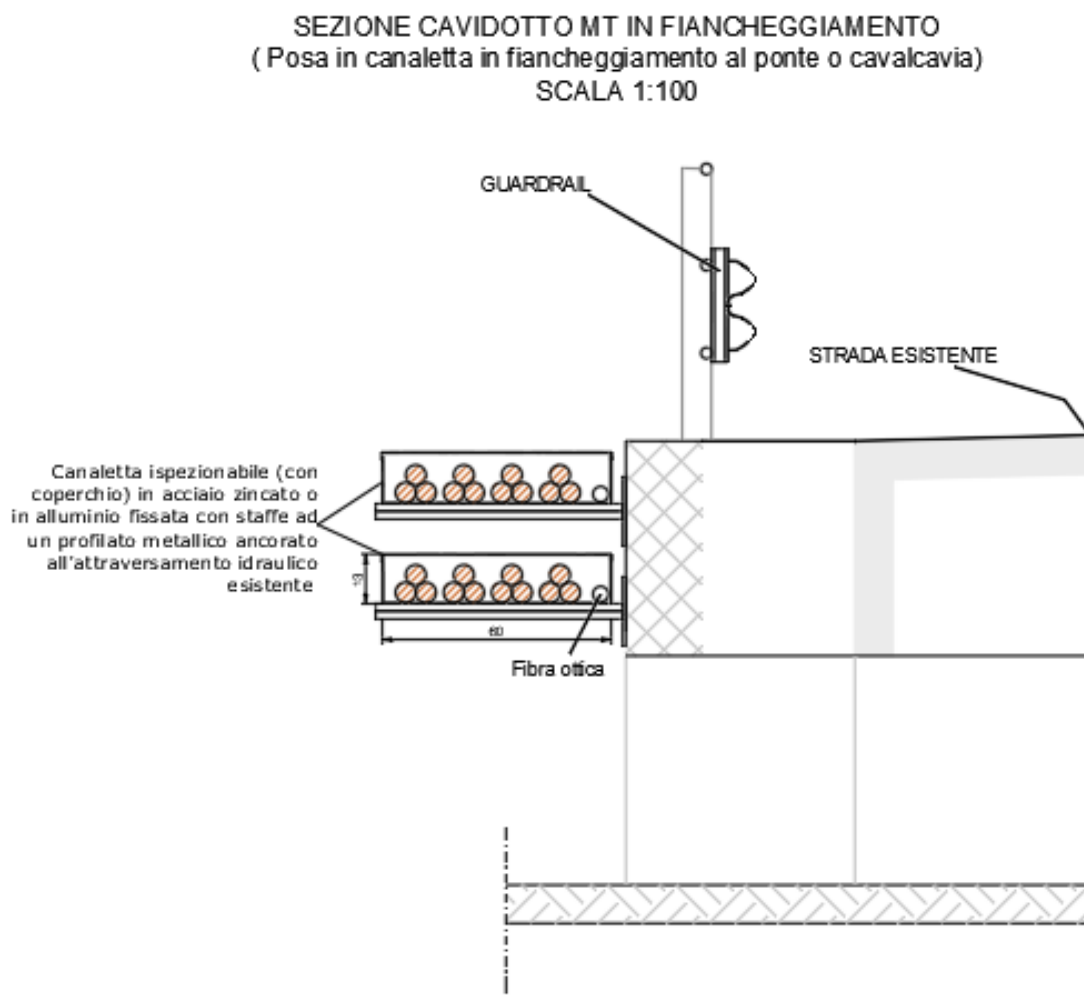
Tipologico sezione cavidotto MT in fiancheggiamento al ponte/cavalcavia
